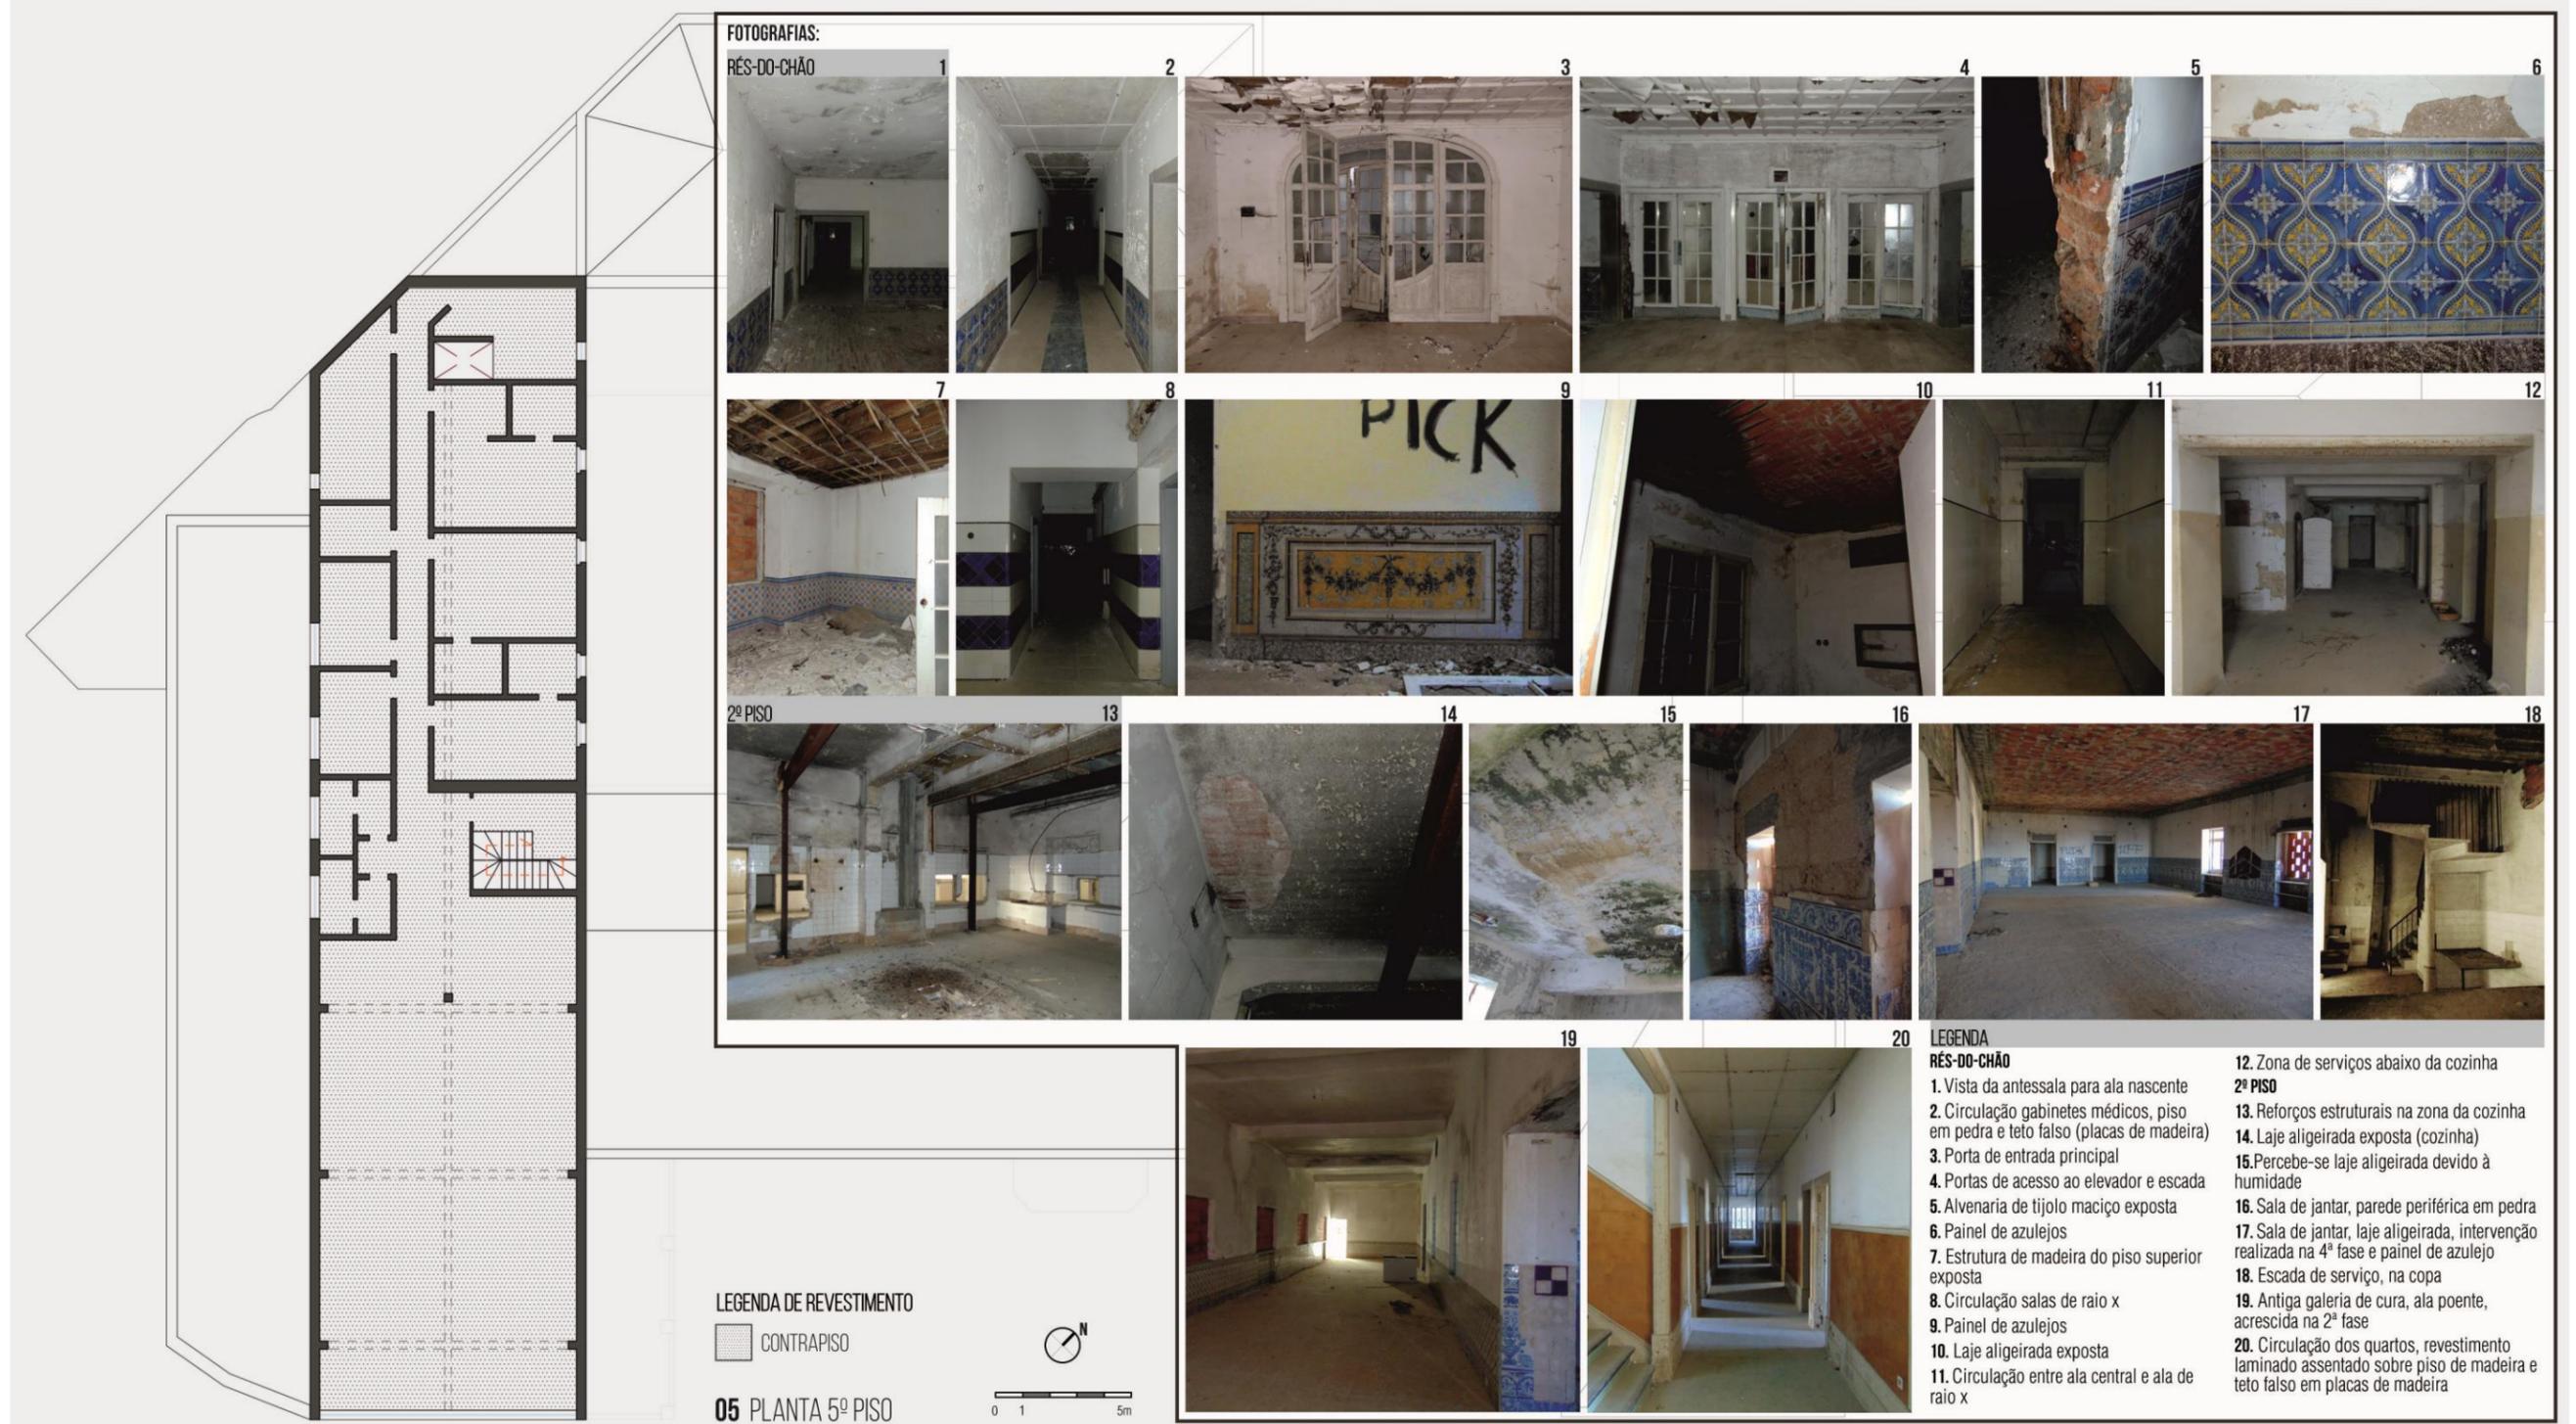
Planta de Revestimento – 5º Piso – e fotografias gerais (planta base desenvolvida a partir da cópia da planta original)
